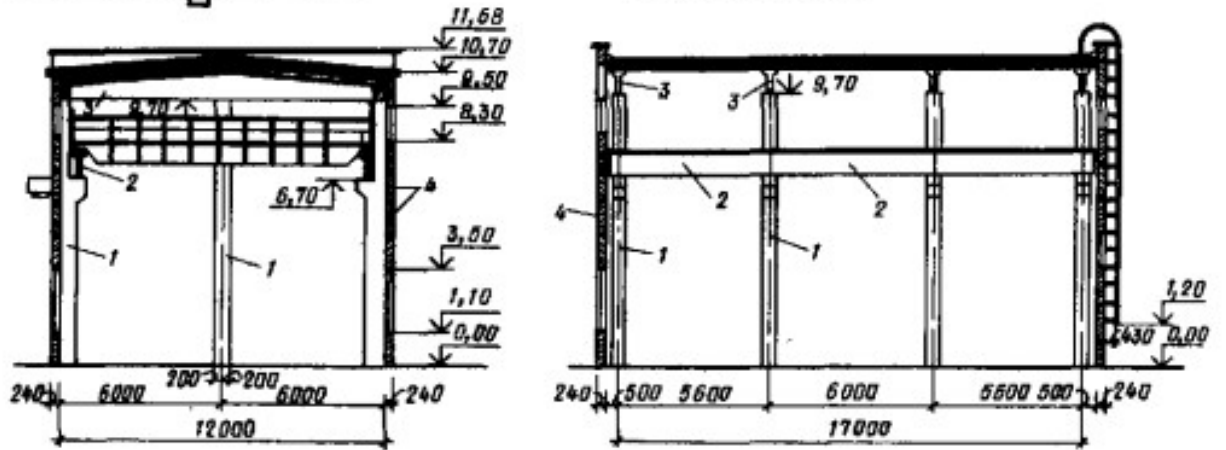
Верхнее строение здания насосной станции каркасной конструкции
